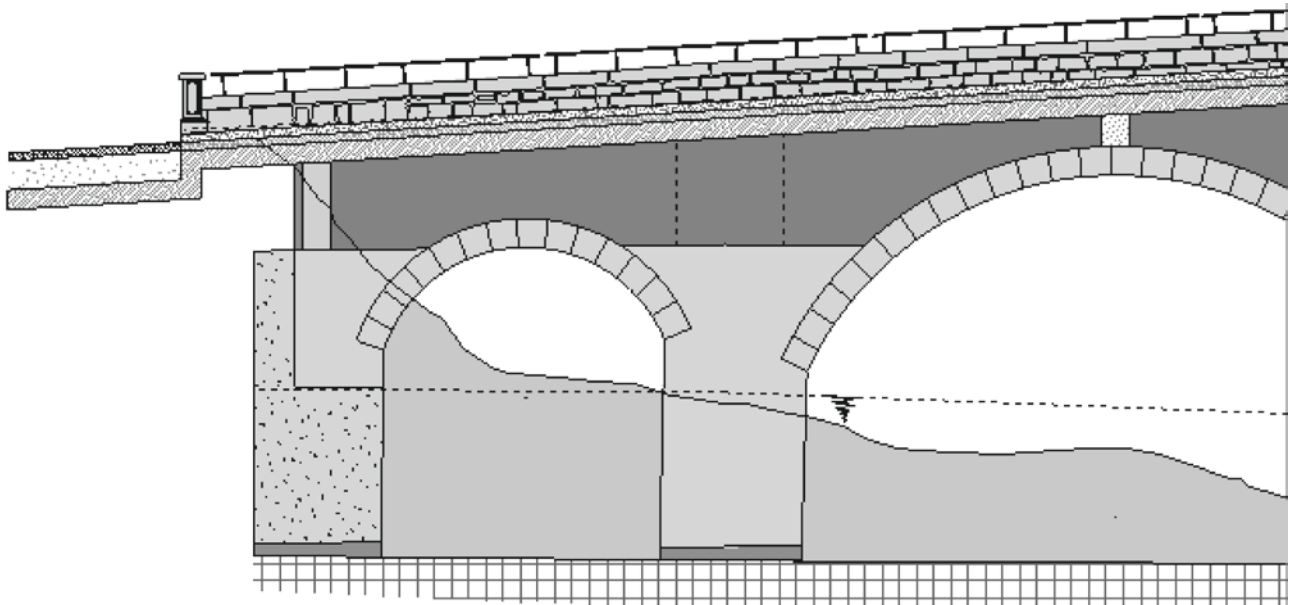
Ausschnitt Stahlbetonüberbau am linken Widerlager
